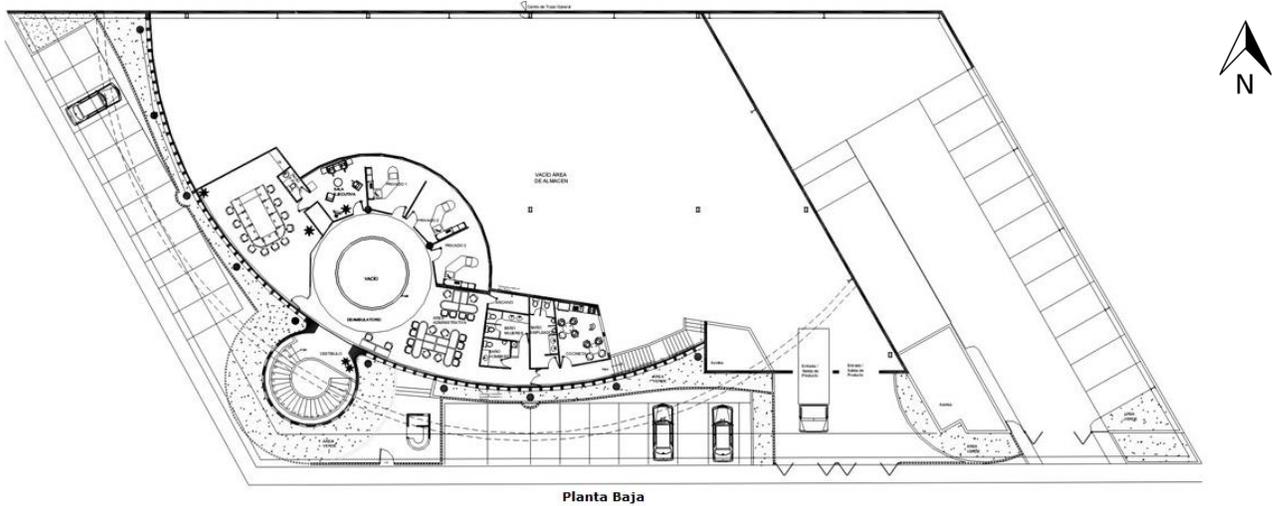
Planta arquitectónica baja. (Sin escala)
